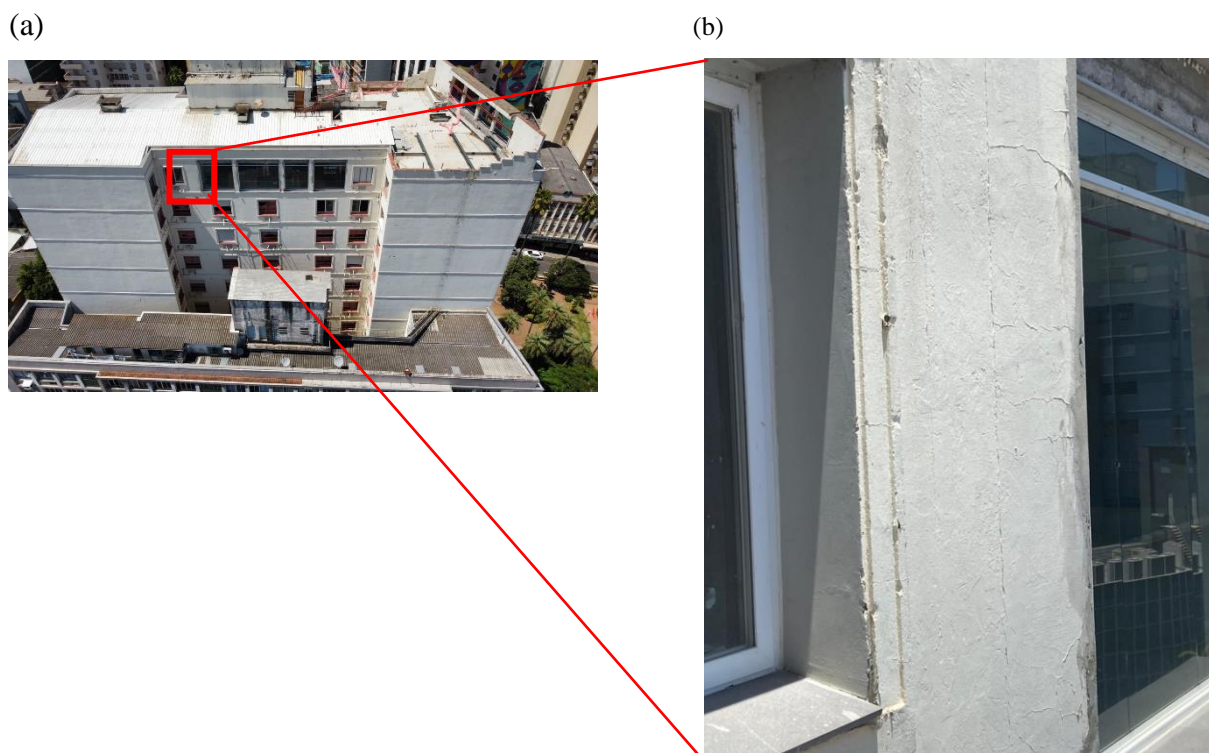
(a) localização e (b) inspeção de fissura ao lado de janela existente do 4º pavimento.
